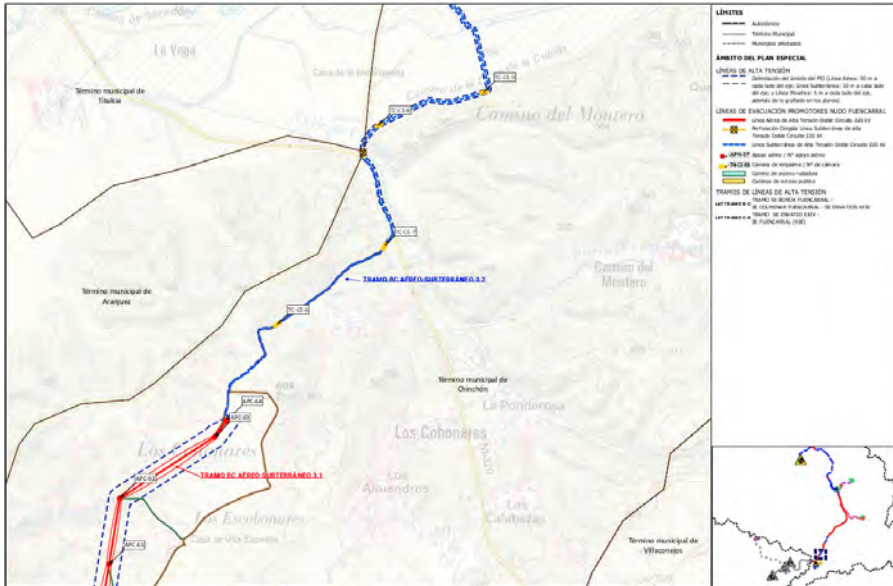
Plano de Ordenación 02.3.2. Planta por tramos. LASAT Promotores Nudo Fuencarral Tramo B-C
